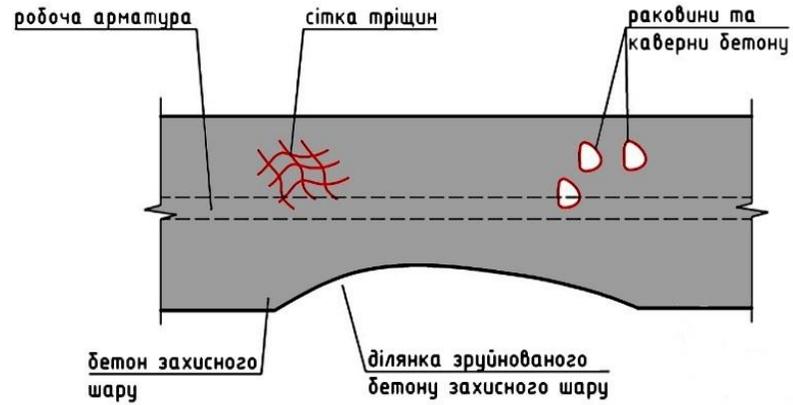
Схема для виконання відновлення геометричних параметрів поверхонь бетонних та залізобетонних конструкцій кріплення греблі з ґрунтових матеріалів
